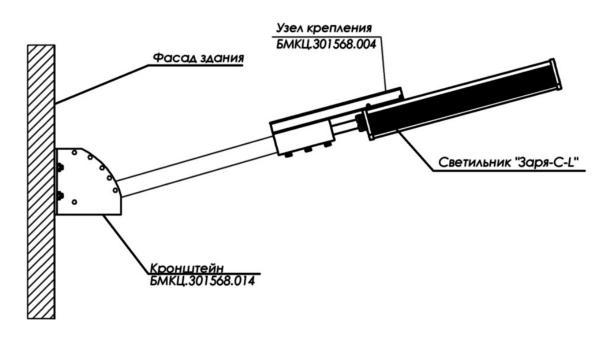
Установка светильника на фасад здания с помощью узла крепления БМКЦ.301568.004 и кронштейна «Заря-К-14» (БМКЦ.301568.014).
